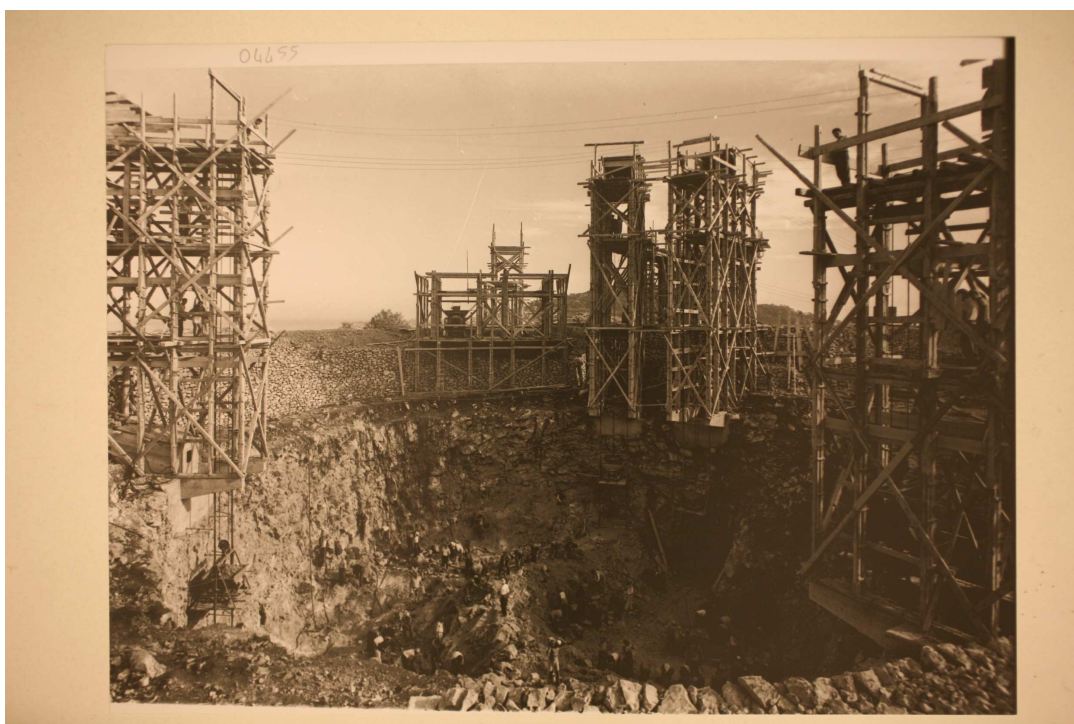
, Archivio Vasari, (Cantiere aviorimessa I tipo), 1935, CSAC, sezione fotografia.
